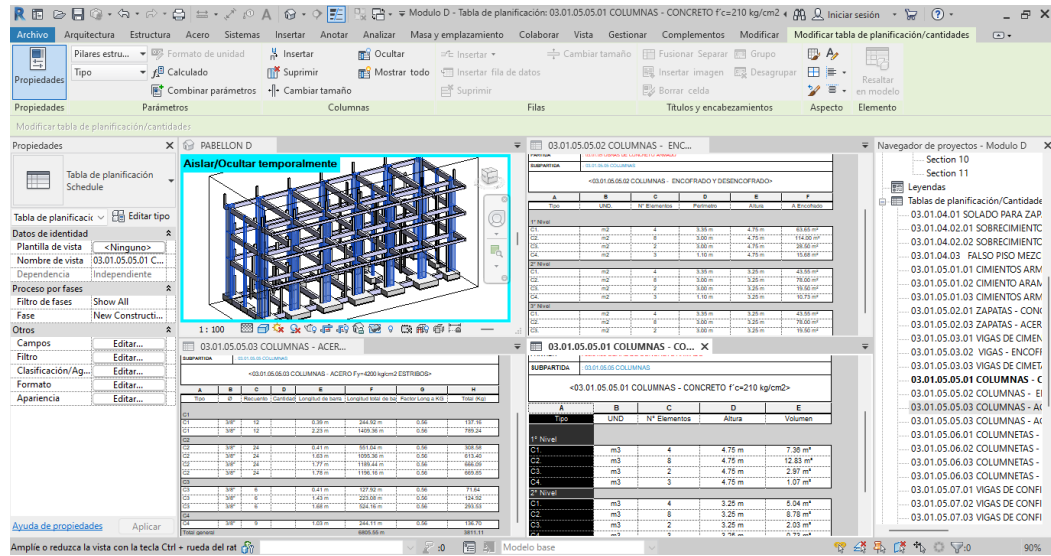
Modelado y metrados de la partida Columnas Módulo D
